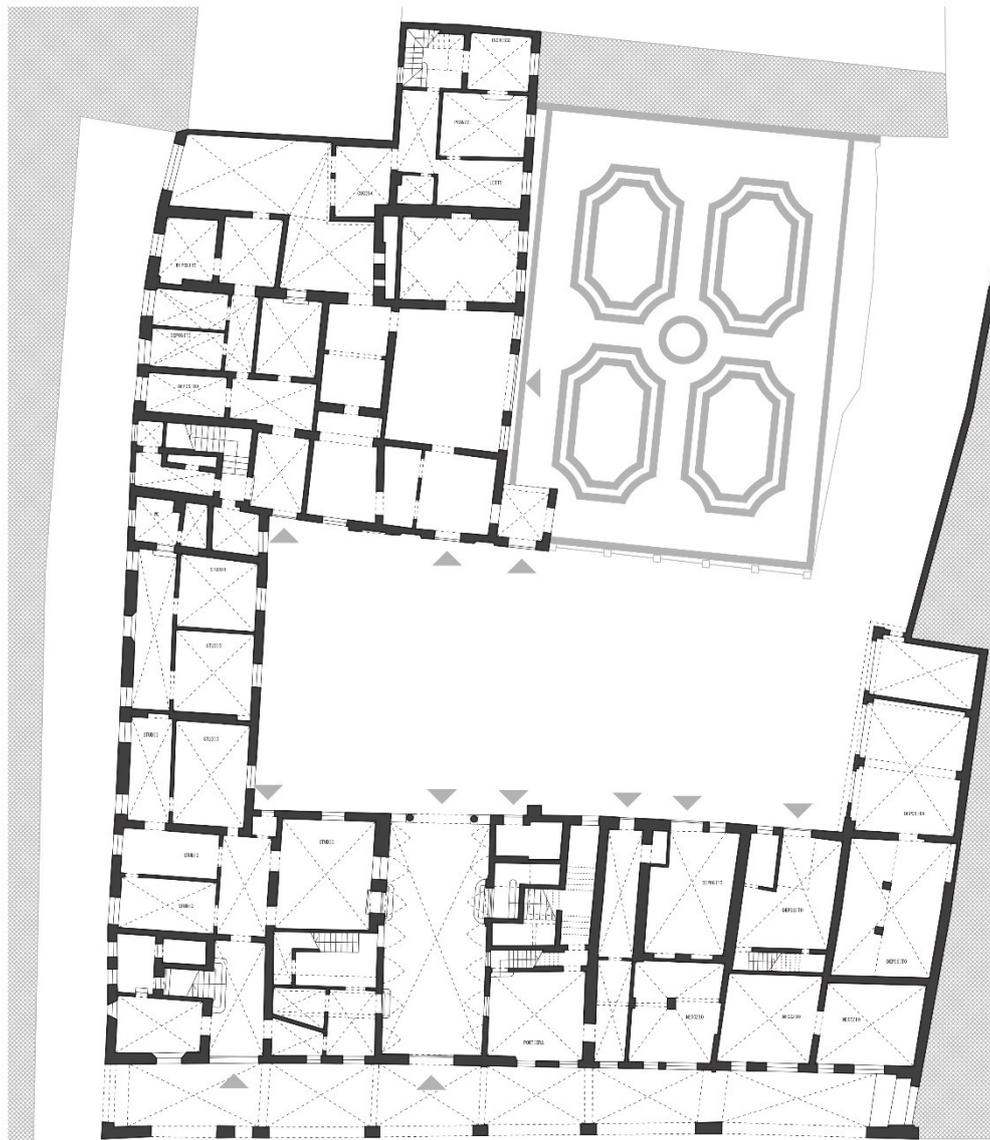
Palazzo Selvatico, Padova, via Vescovado. Pianta del piano terra.
